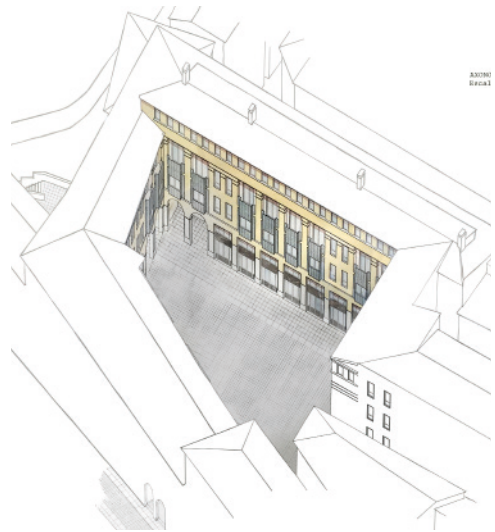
Barbacana: prospetto su Plaça de les Xiques.
